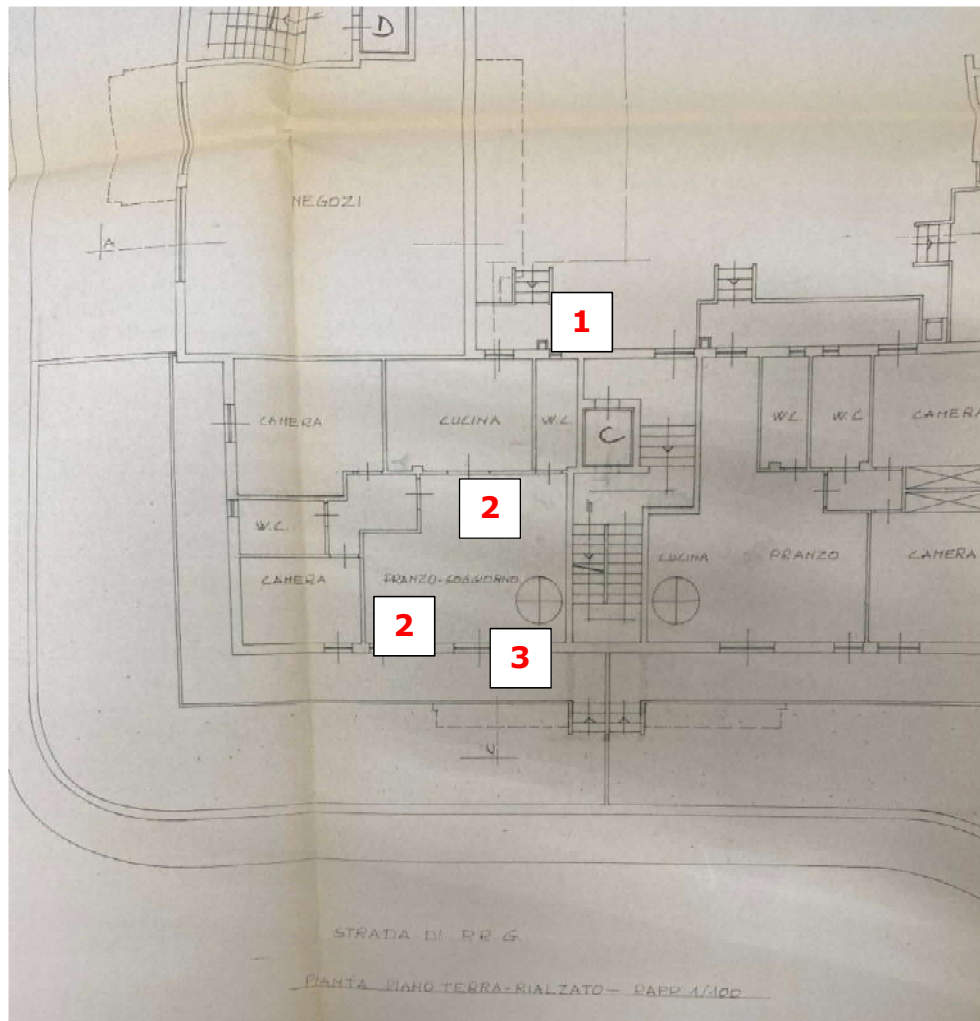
Stralcio di progetto C.E. n. 10685 del 04/02/1991
